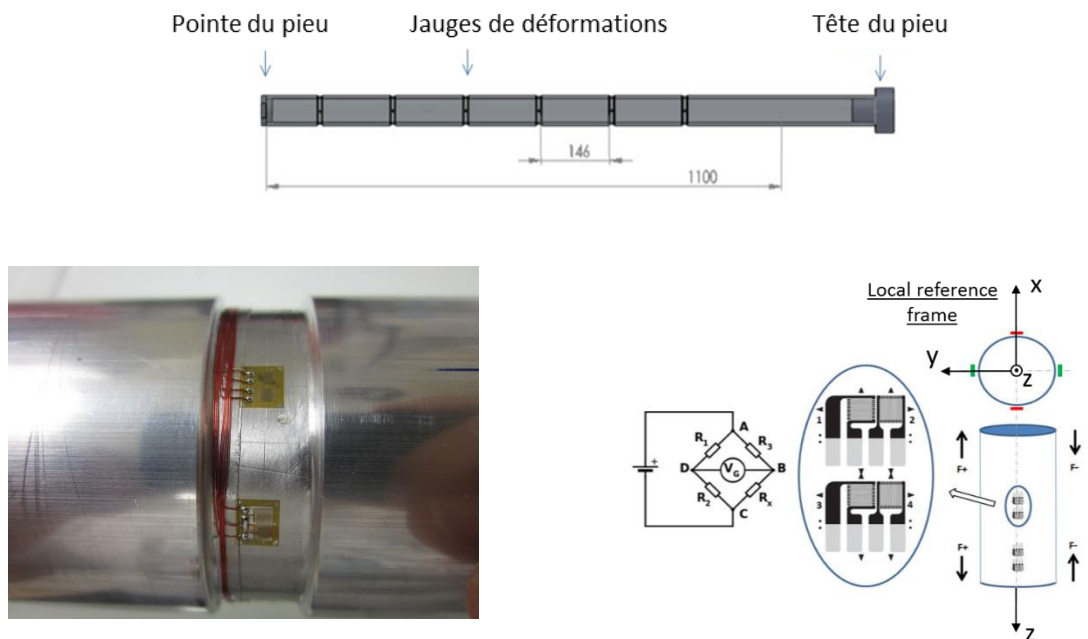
Schéma des positions du pont de jauges sur le pieu (sans protection)
